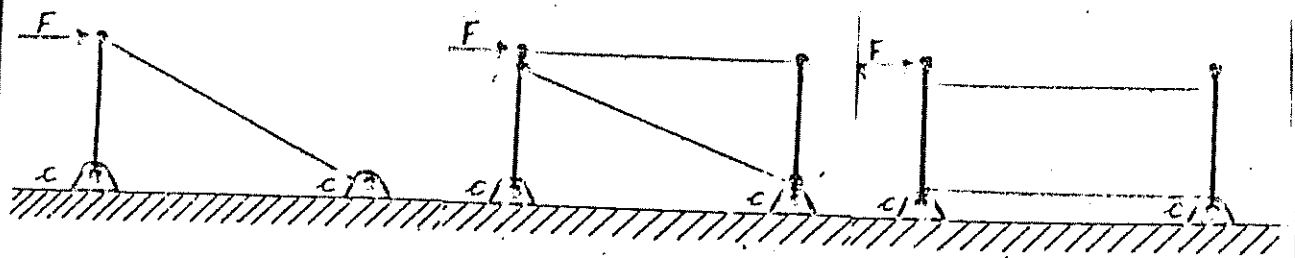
Prova di rigidità di schema funzionale in pianta (compressione)
